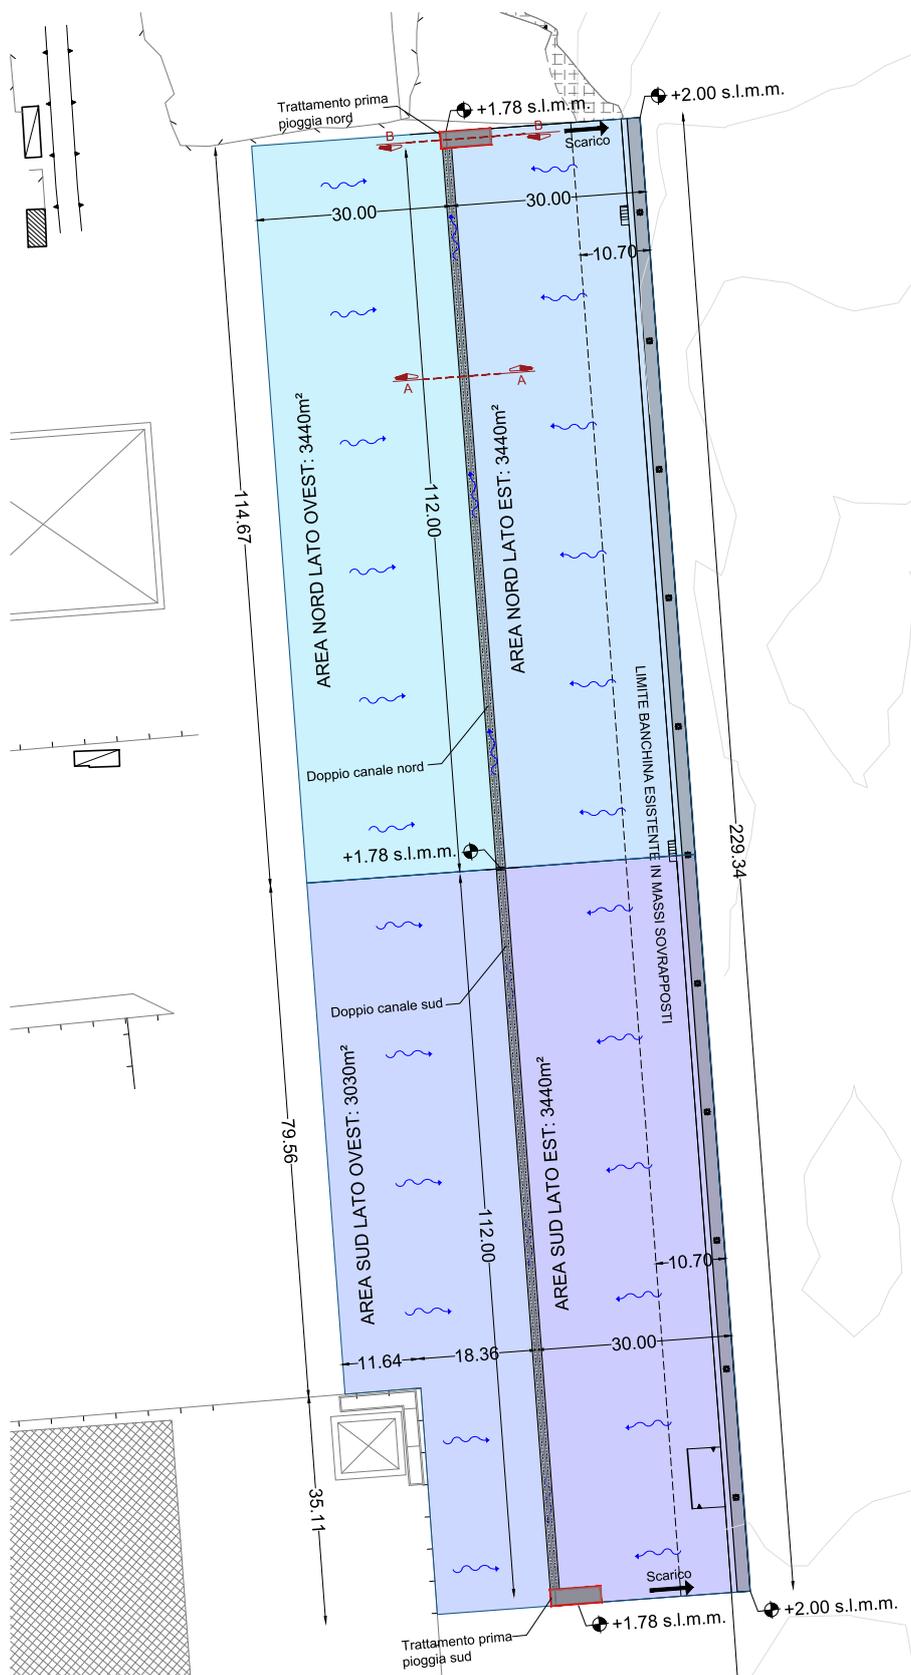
Planimetria della rete di drenaggio delle acque meteoriche
